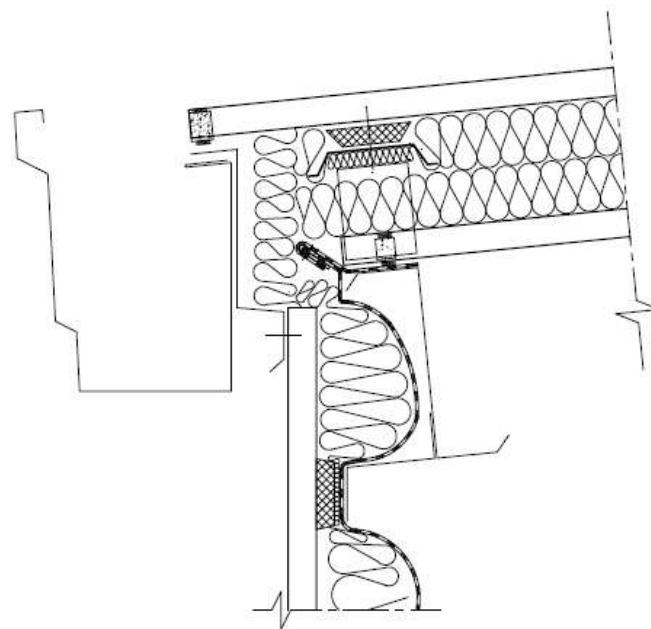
6: Beispiel für einen Dachrandabschluss, Wand aus Sandwichplatten, Industriedach mit Stahltrapezprofilen, als zweischalige Konstruktion
